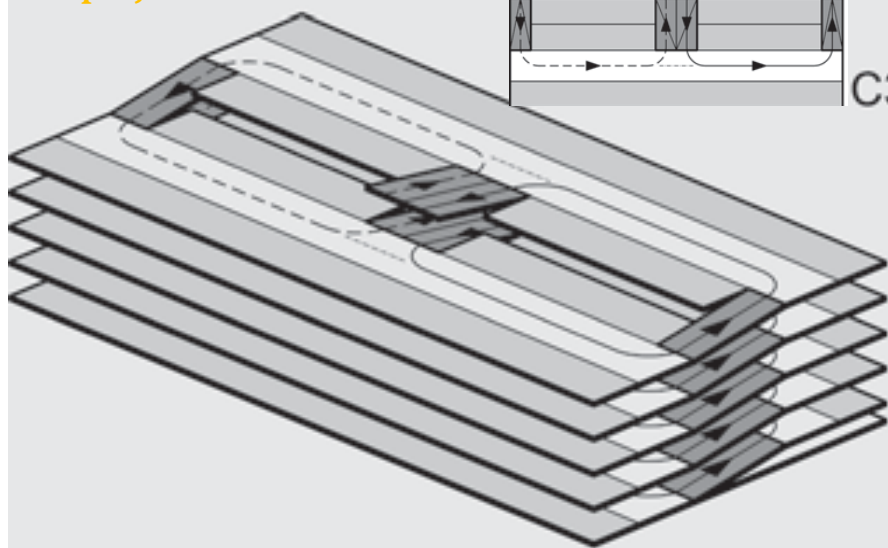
bis 132 Parkhaus Breuninger in Stuttgart, 1963 mit dem Paul-Bonatz-Preis der Stadt Stuttgart ausgezeichnet
